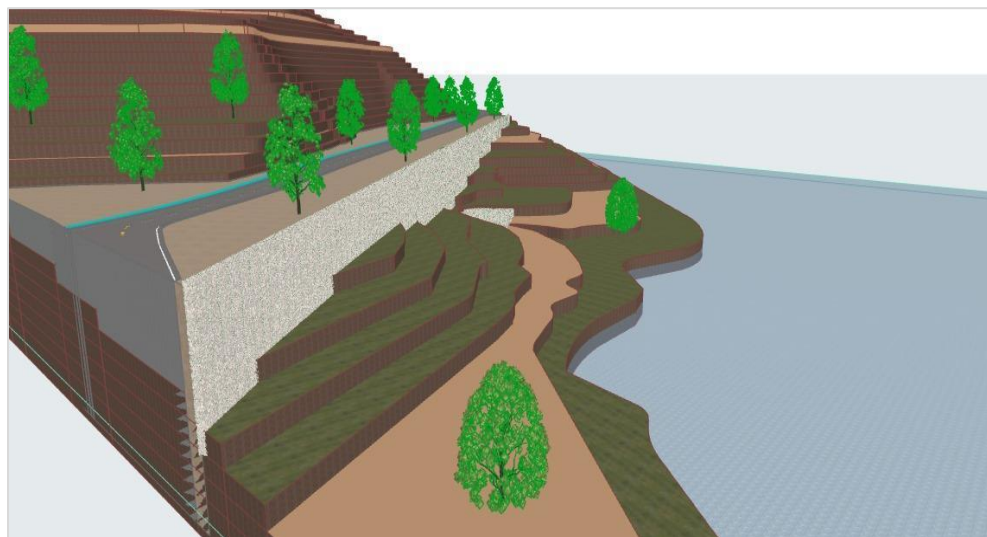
Modelado Bim del muro de gaviones con vista sección transversal
